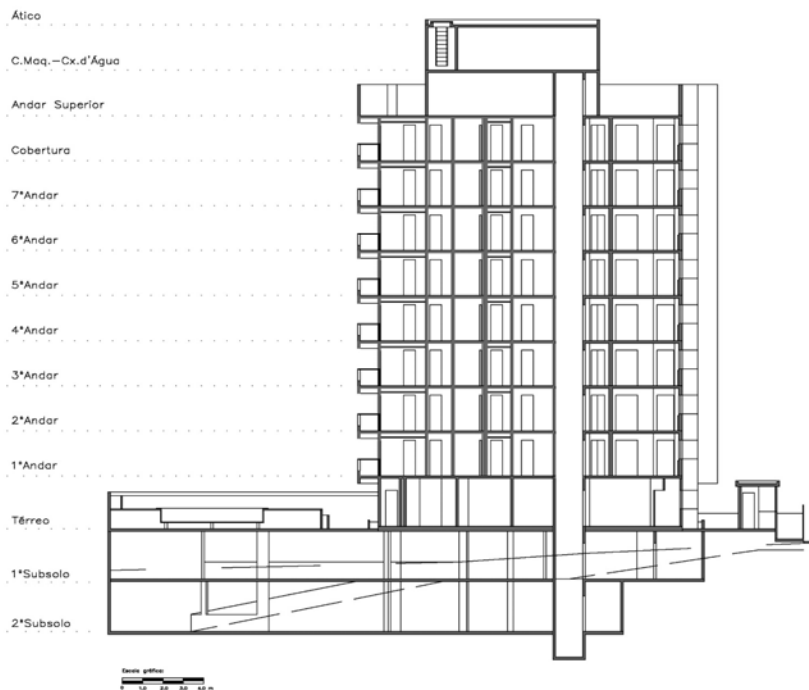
Planta digitalizada do corte longitudinal (2006)
